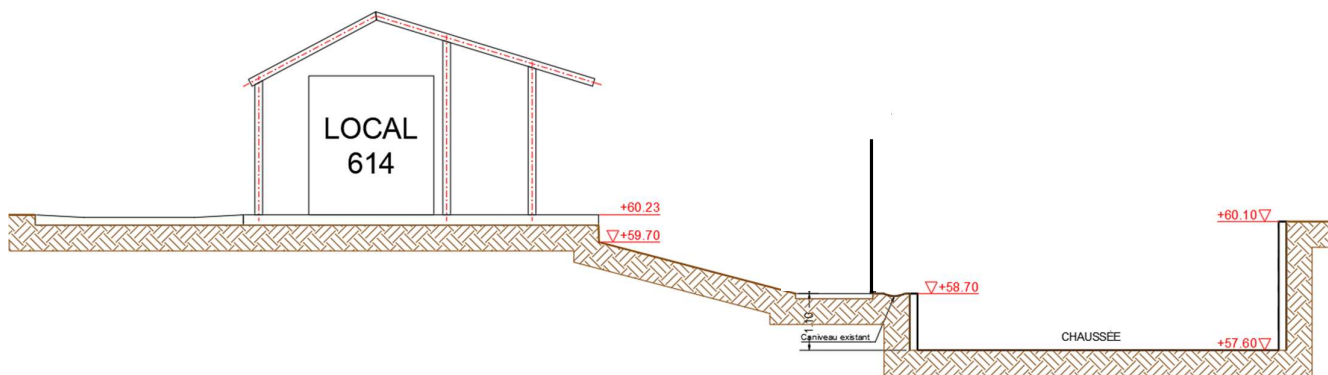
Coupe-type DD sur la zone 3 [R 3]
